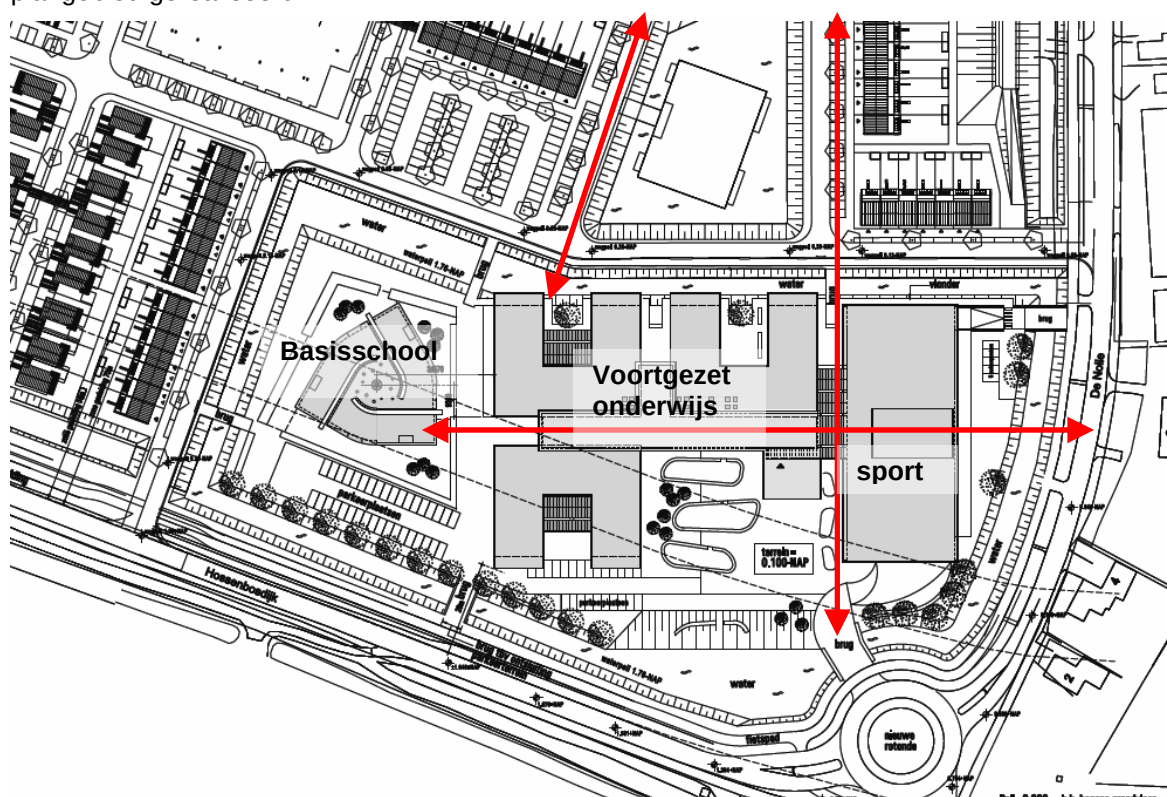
Zichtlijnen vanuit de woonwijk en openbare weg op het plangebied
